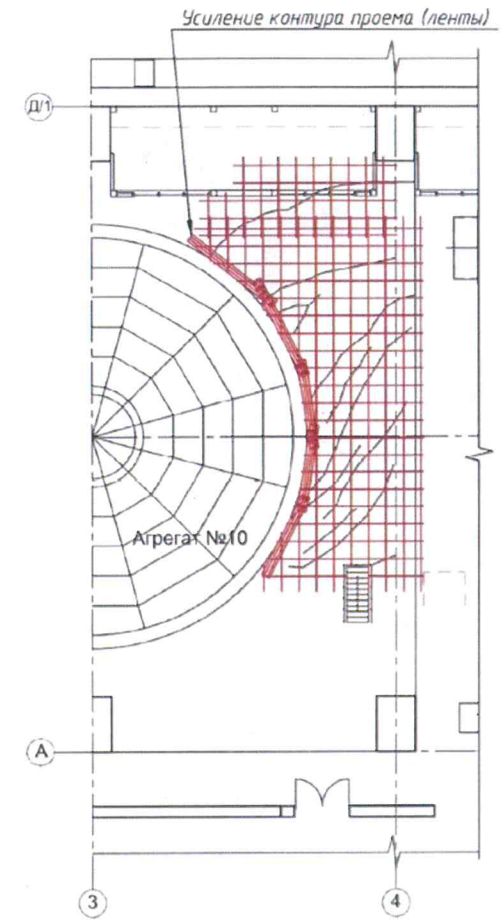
Усиление перекрытия машинного зала здания ГЭС
